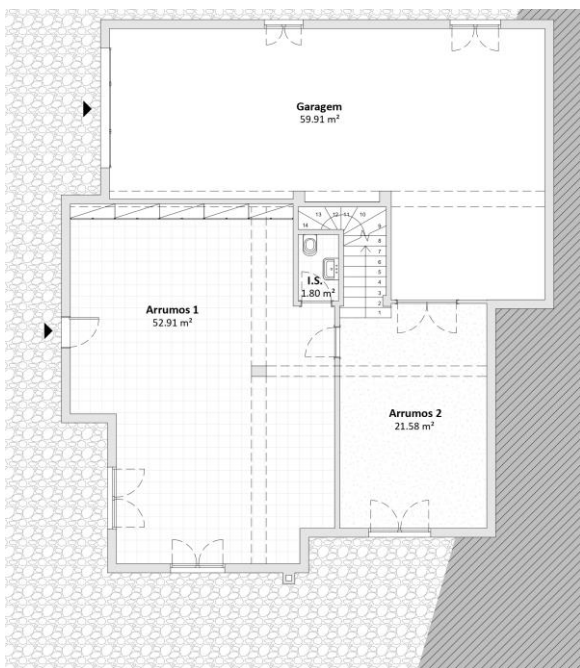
Existente - Planta da cave. Fonte: Garq / Desenvolvimento: Autora.
